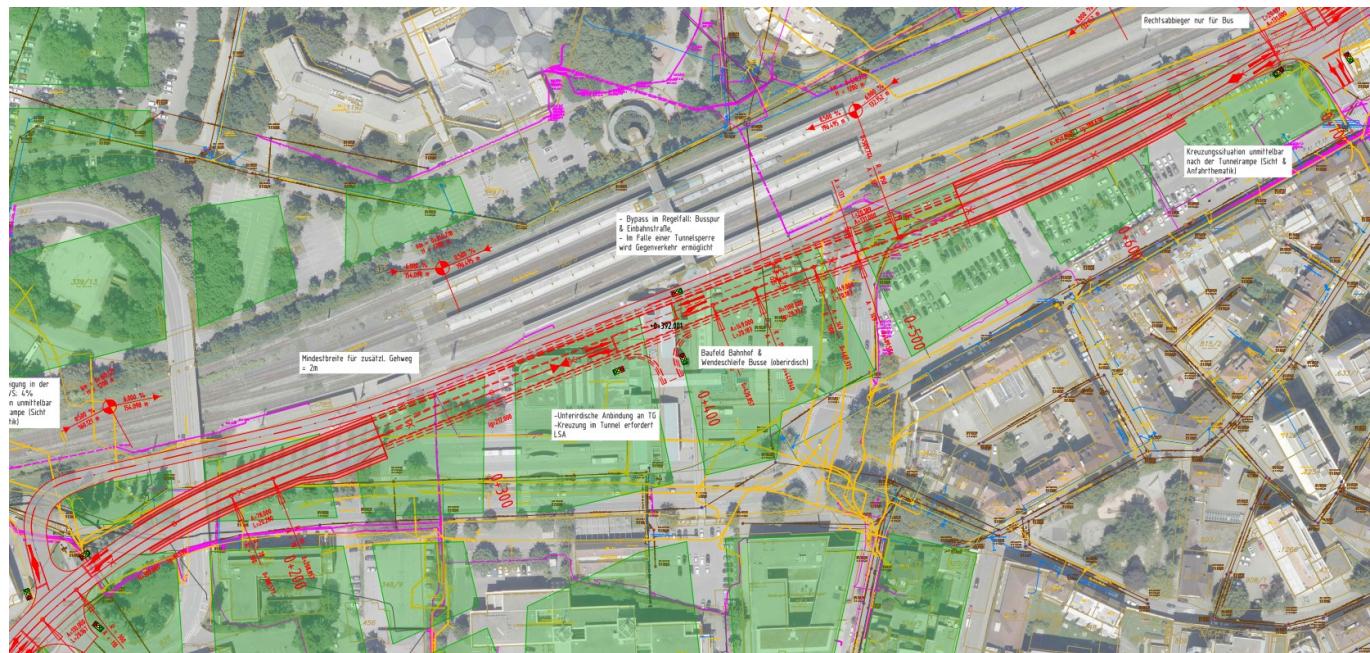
Ausschnitt Lageplan Variante 3 – kurzer Tunnel
